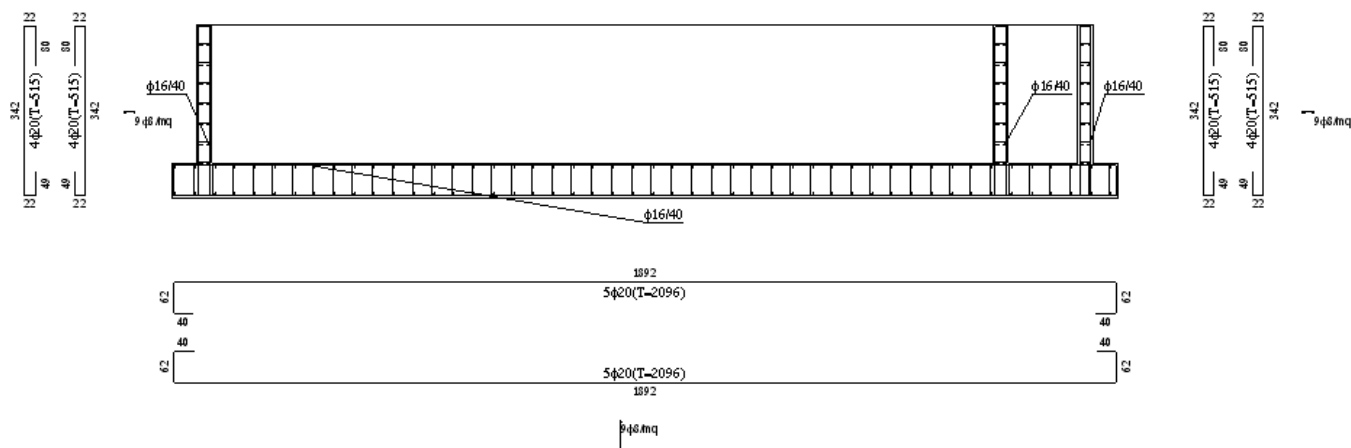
Schema delle armature, sezione longitudinale dell’opera di derivazione (spessore piedritti 30 cm)
